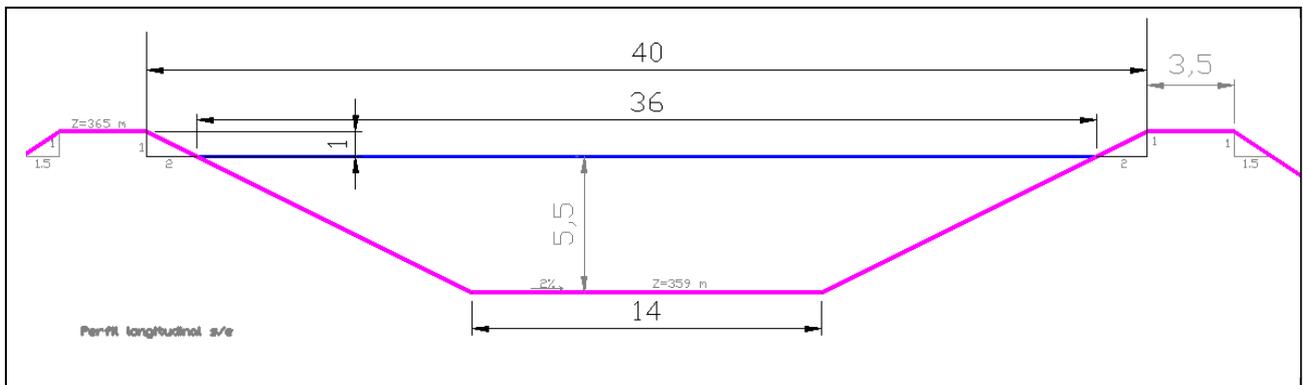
Sección longitudinal de la balsa. S/E. Corte B-B'
